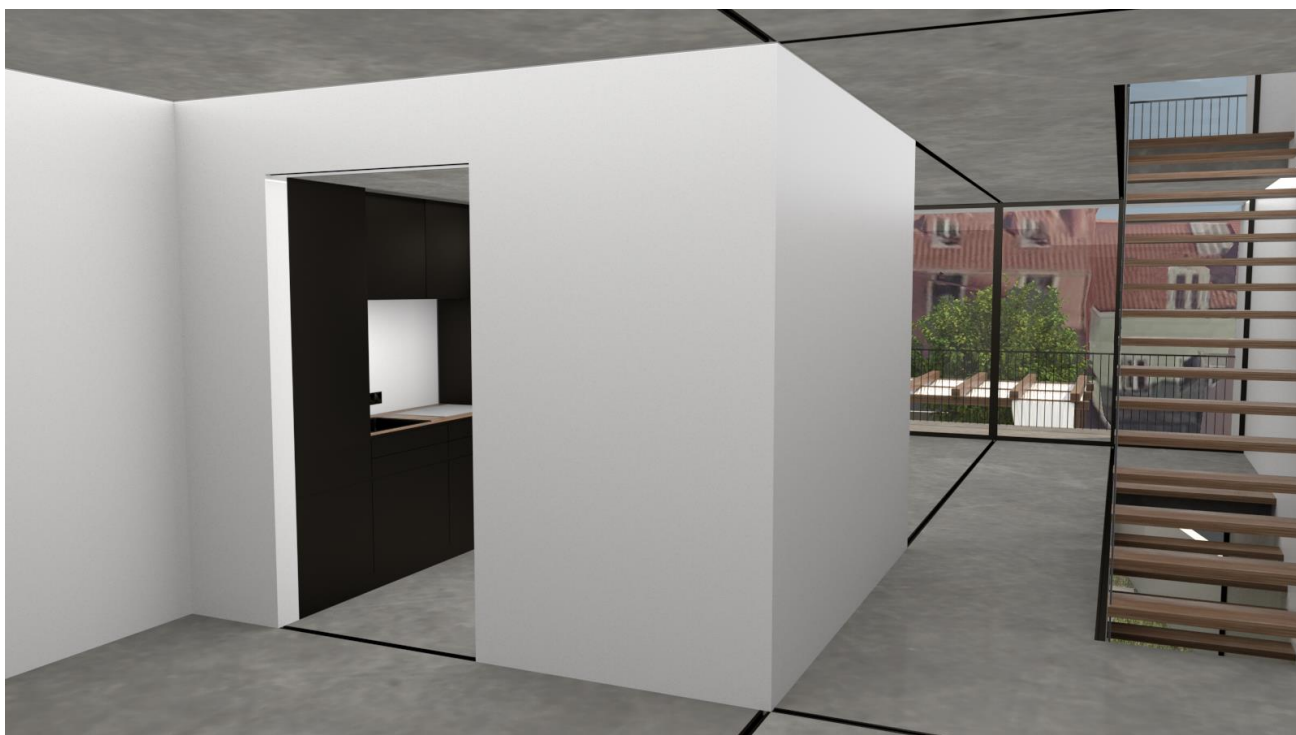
Render Interior Piso Tipo, Vista para o Exterior (Fonte: Autor)
